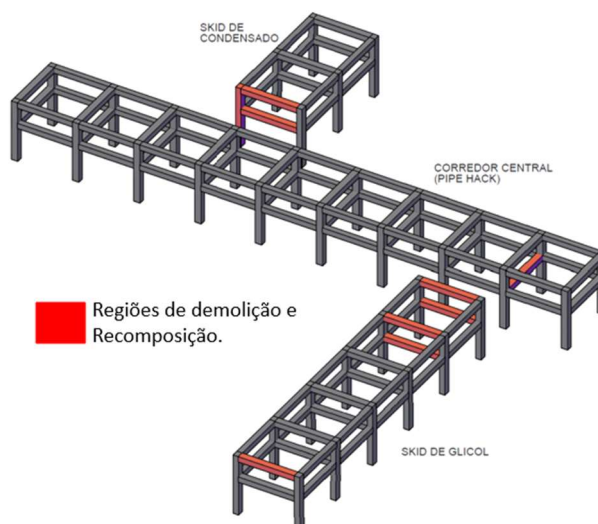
Indicação dos pilares e vigas definidos como componentes do escopo.
